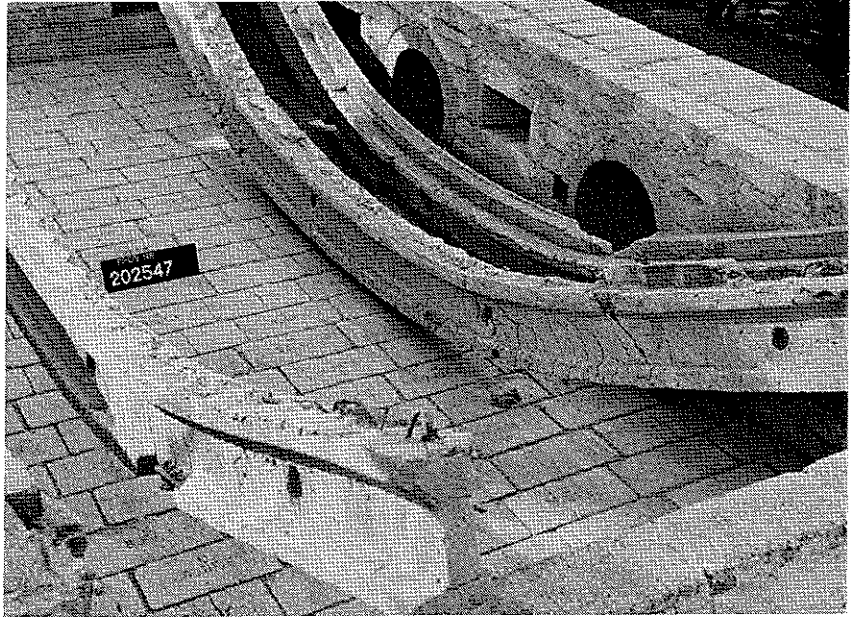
Armerad betongbalk, provad till brott under brandpåverkan.
